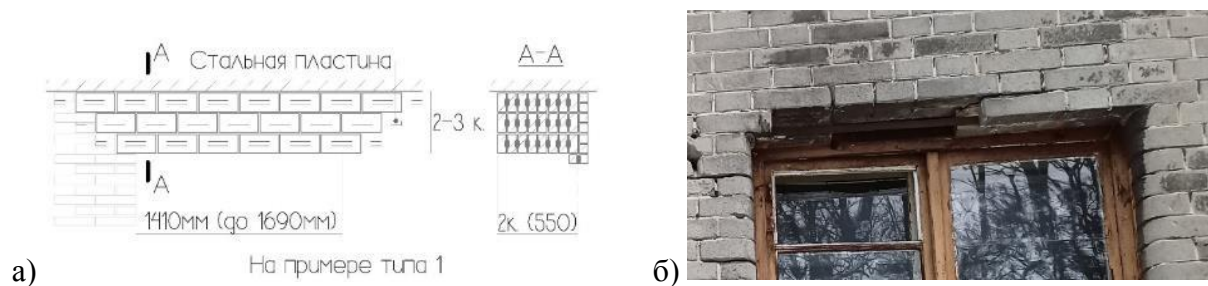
а) – конструкция перемычек малого пролета (до 1,7 м) – дома типов 1, 2, 3, 3а (схема), б) – армирование лицевой кладки полосовой сталью (фото)
